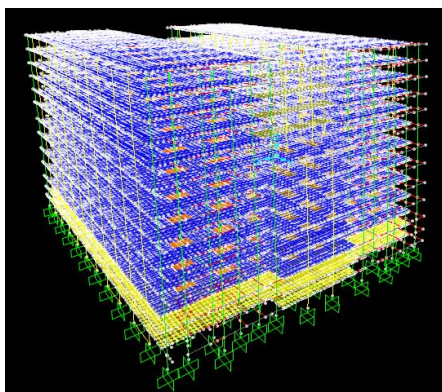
Modelo Estrutural adotado, modelado no "SAP2000"
